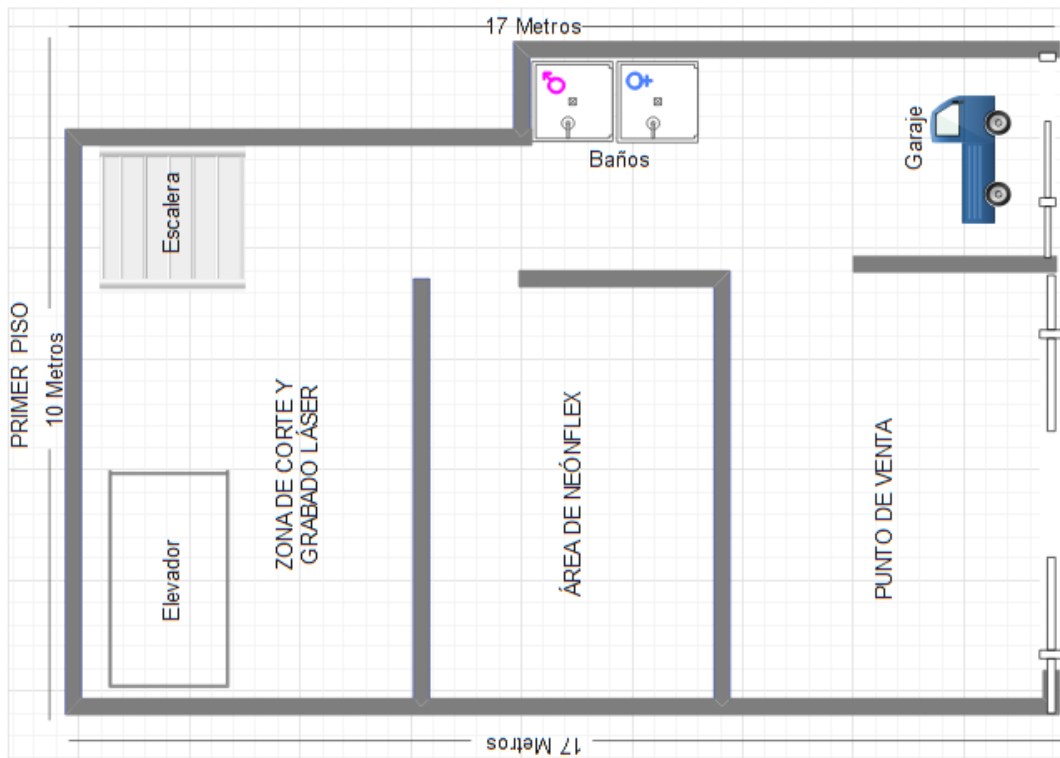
Distribución de planta Primer piso. Elaboración propia
